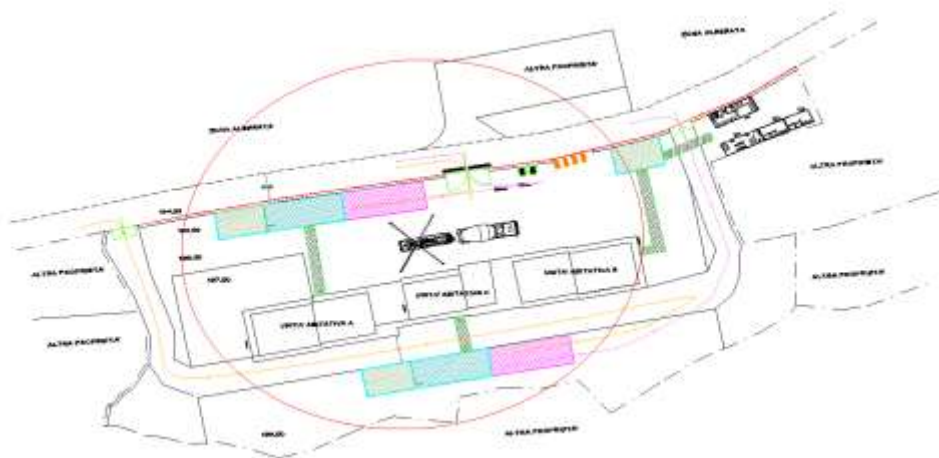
Stralcio di cantiere durante la fase del getto di fondazioni
